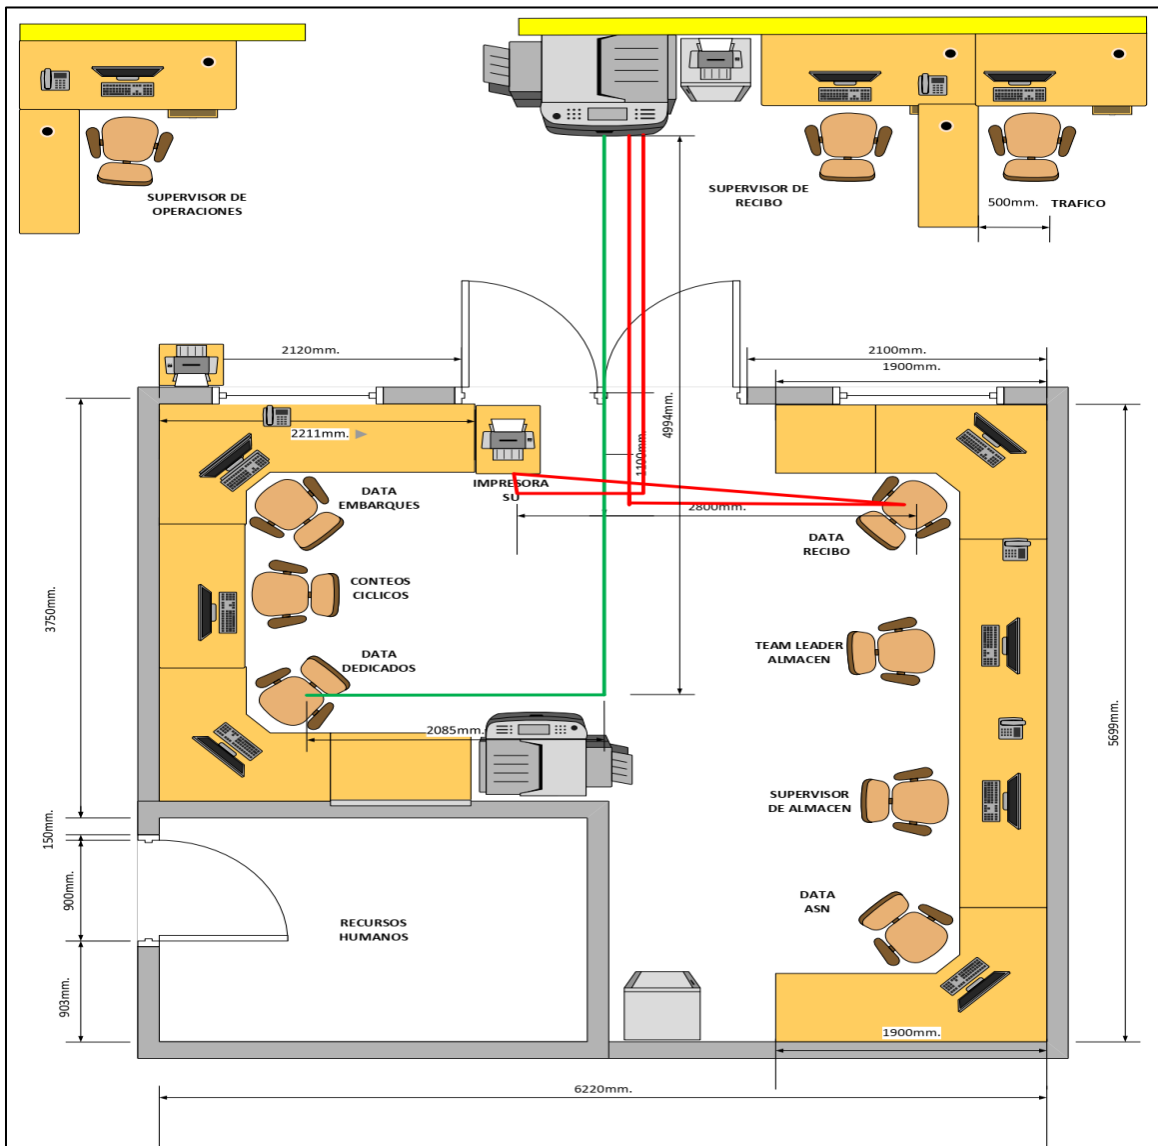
Plano Detallado de las Distancias y de la Ubicación de las Impresoras.
